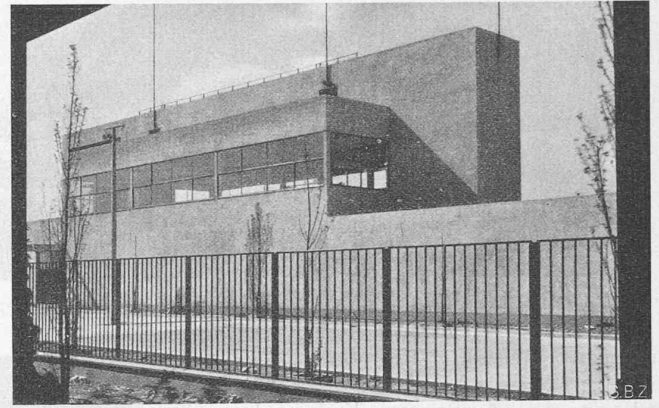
Turnhalle vom Erdgeschoss-Hof des Schulhauses aus.
